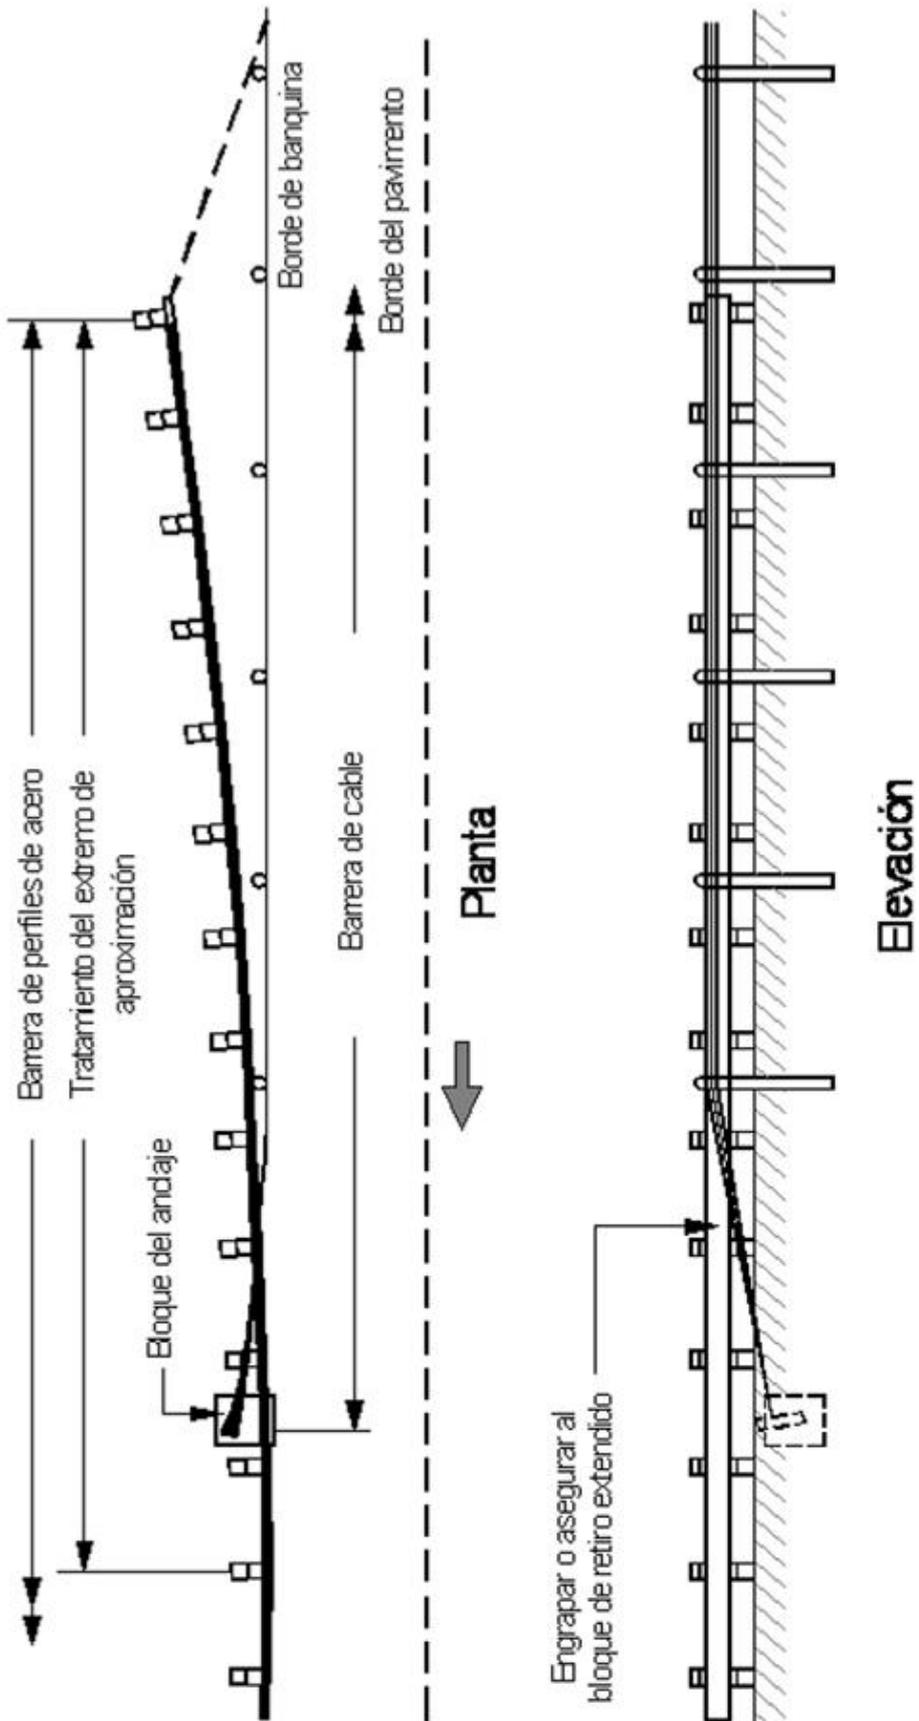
TRANSICIÓN DE BARRERA DE CABLE A BARRERA DE VIGA DE ACERO
